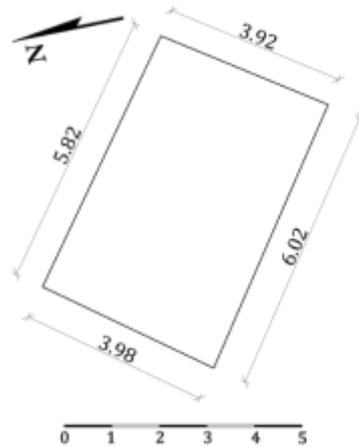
مسقط أفقي للمنور بالدهليز
